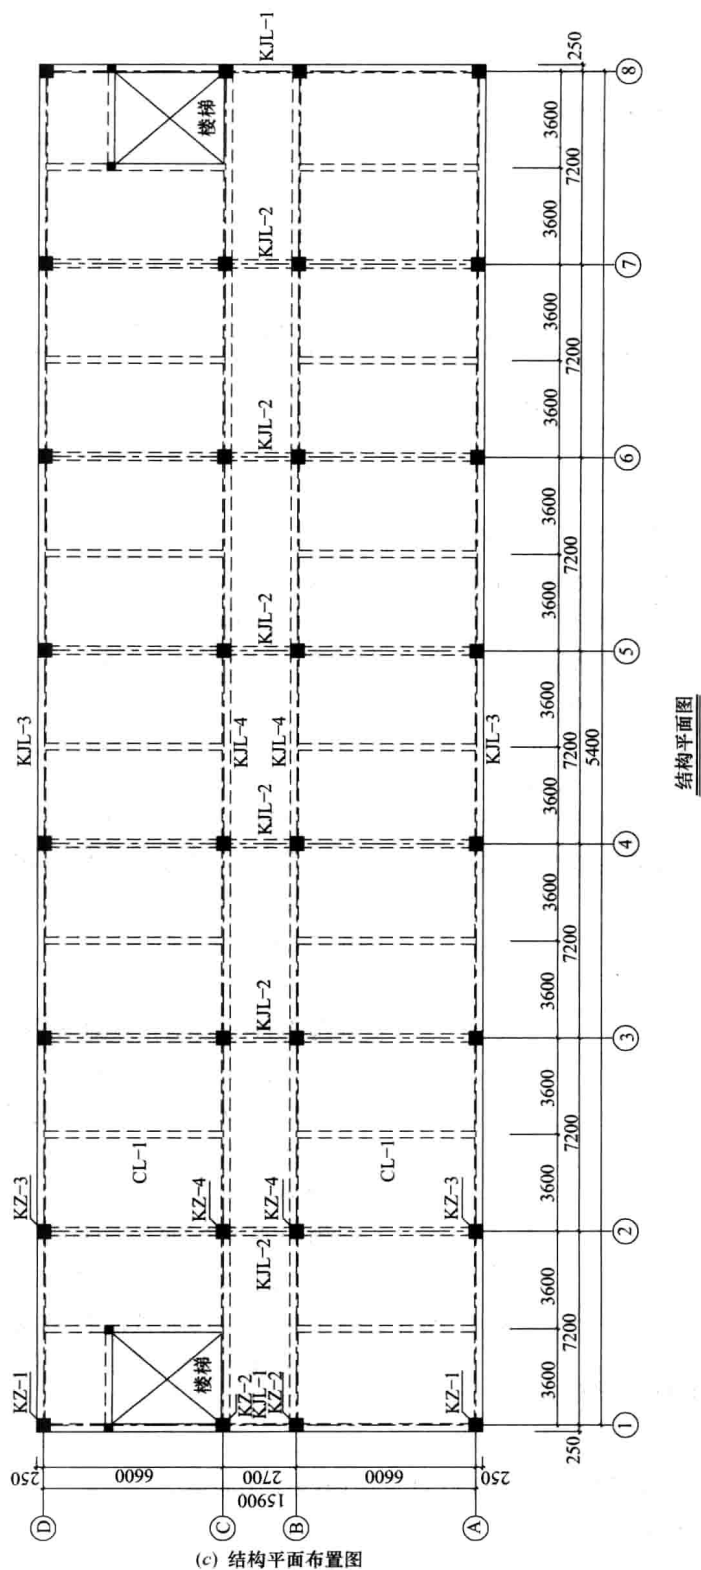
建筑平面、剖面及结构平面布置图 (续)
